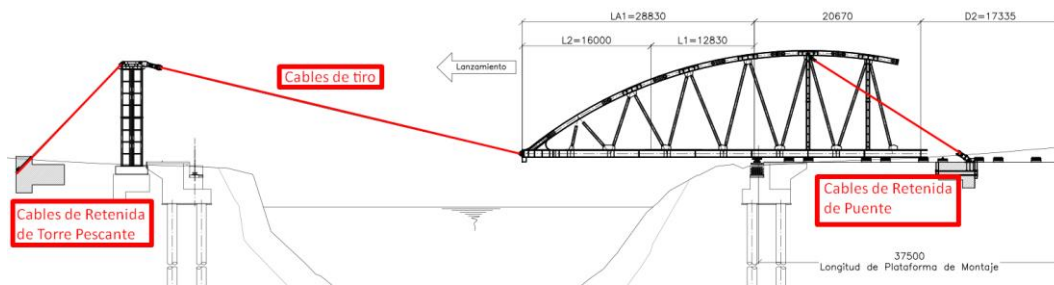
Grupos de cables para el lanzamiento del Puente Chupuro
